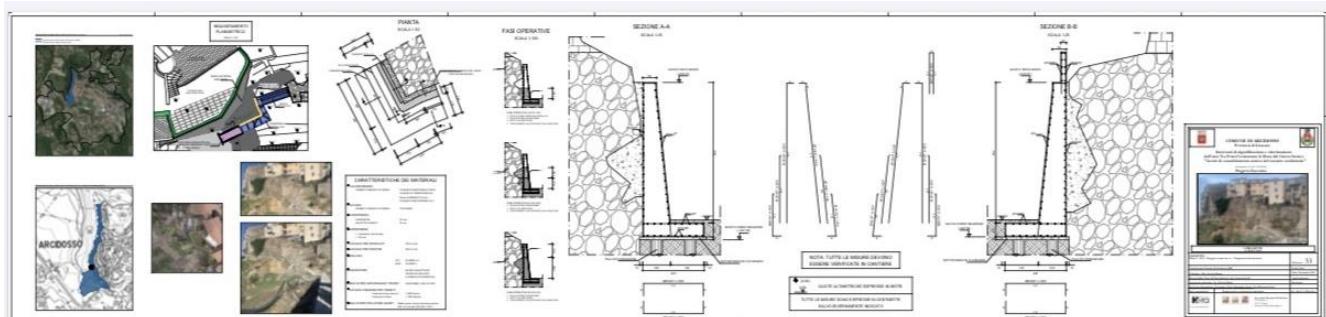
Elab.33 – Zona 5 Progetto muro di controscarpa in c.a
